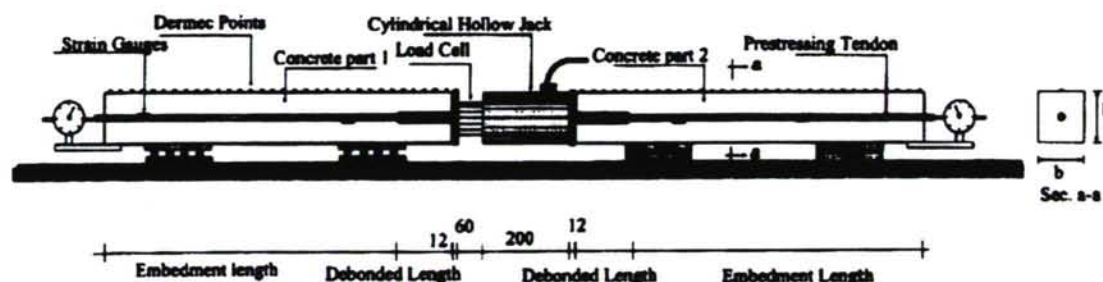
Esquema del ensayo de prisma planteado (MAHM99)
